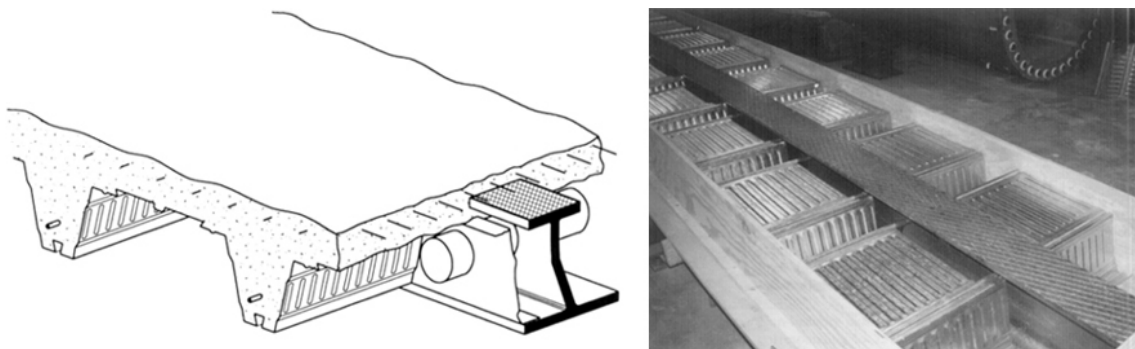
Desenho do sistema *Slimflor*® com fôrma-laje metálica e foto de ensaios estruturais (LAWSON et al., 1997)
